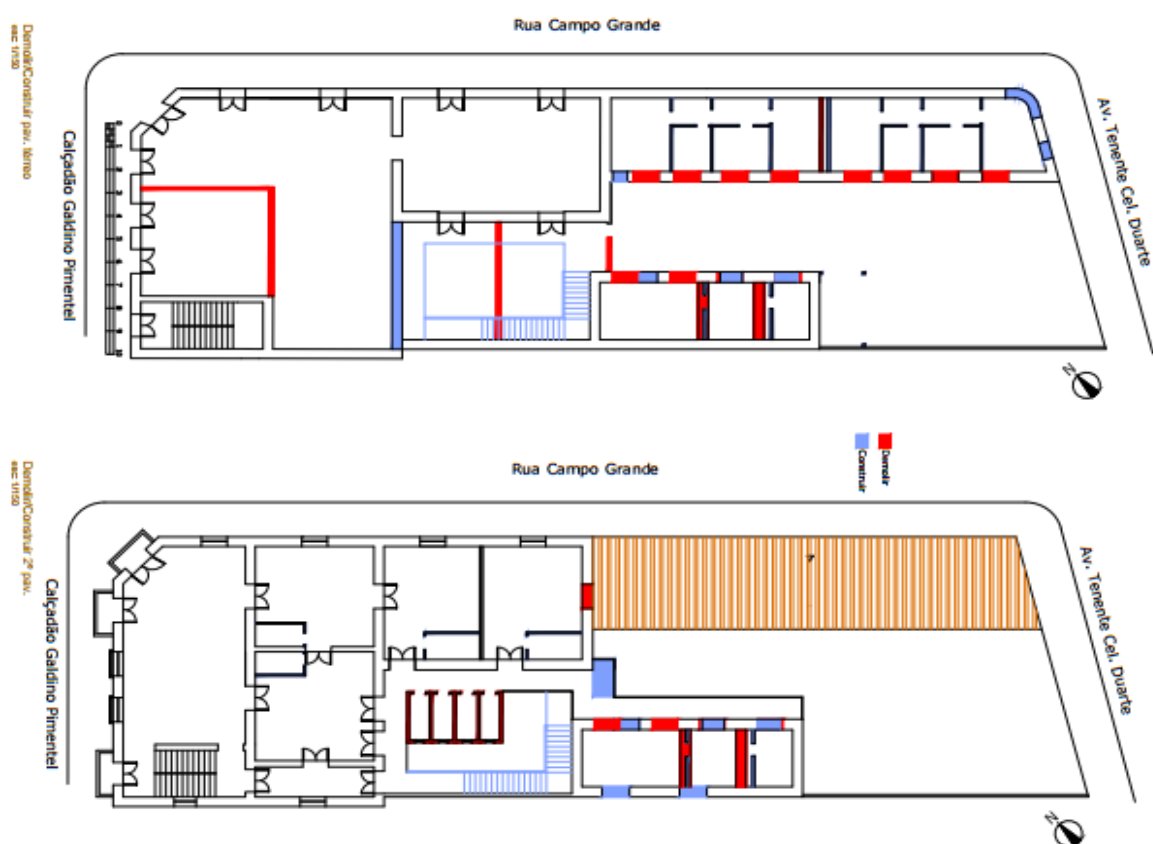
Proposta da Casa Orlando – Demolir e Construir.
